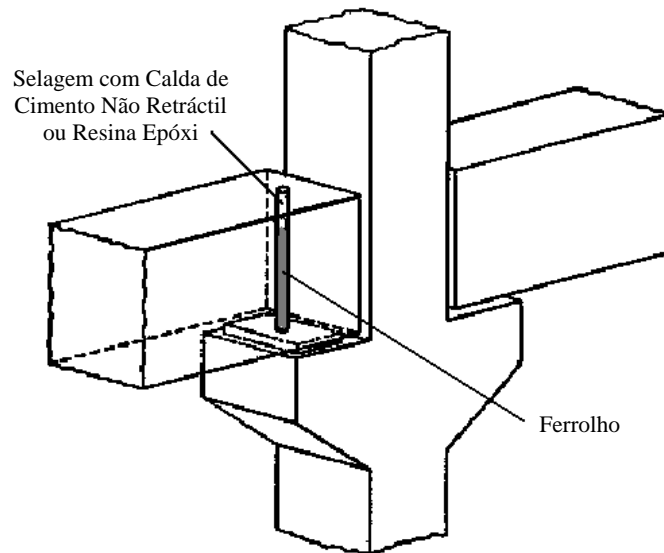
Ligação viga - pilar com a viga apoiada numa consola curta, adaptado de [30]
